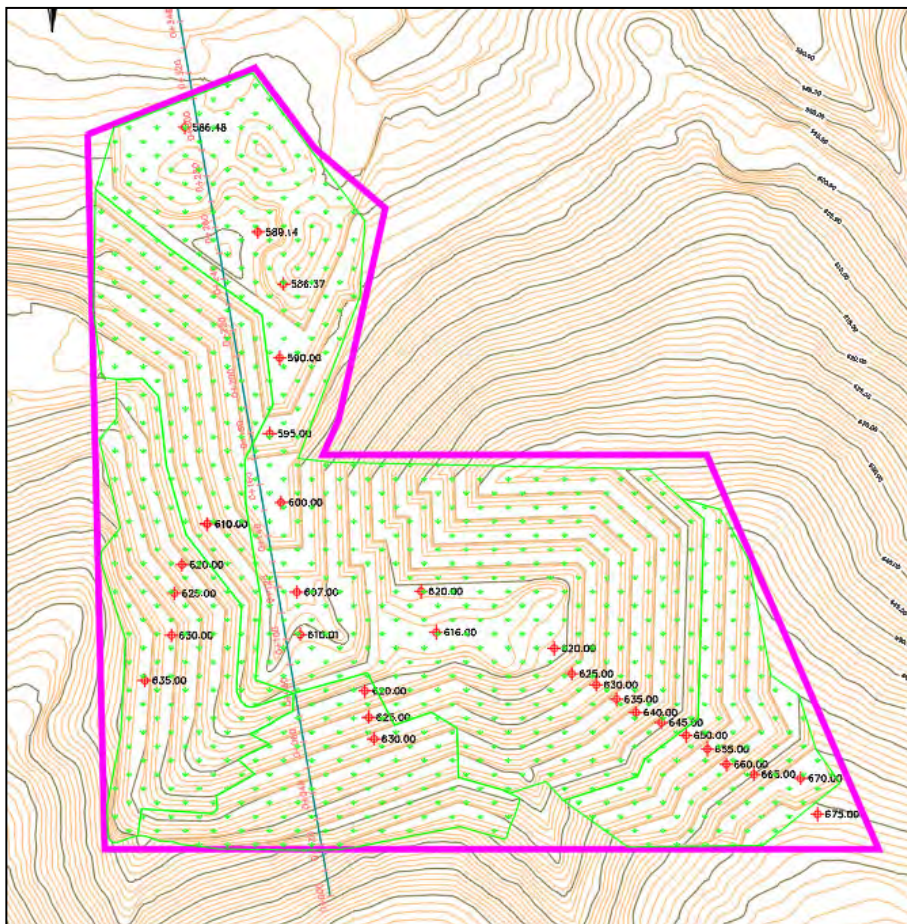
de Explotación-Restauración. Estado final restaurado.
